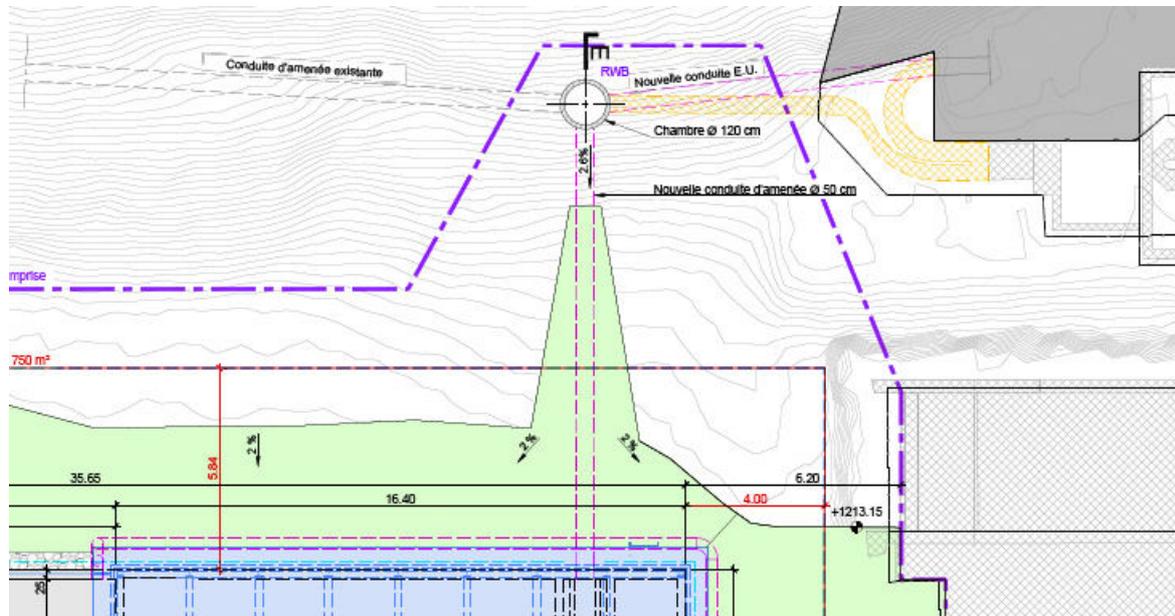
Extrait du plan de dispositions générales – arrivée des eaux
